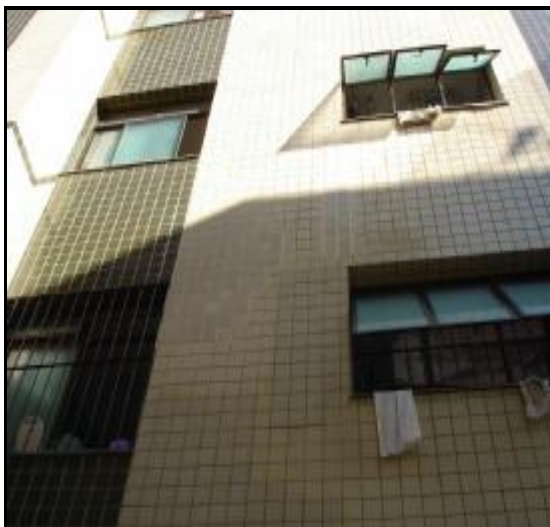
VISTA GERAL DA FACHADA LATERAL DIREITA. NOTAR DIFERENÇA DE TONALIDADE ENTRE PLACAS JÁ SUBSTITUIDAS E O REVESTIMENTO ORIGINAL DO PRÉDIO.
